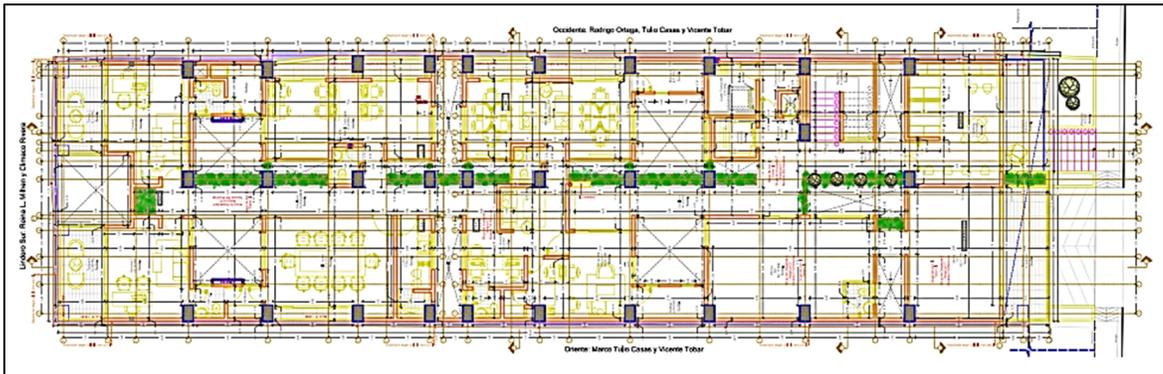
, Planta Arquitectónica Sótano, Fuente: Constructora Open House.
